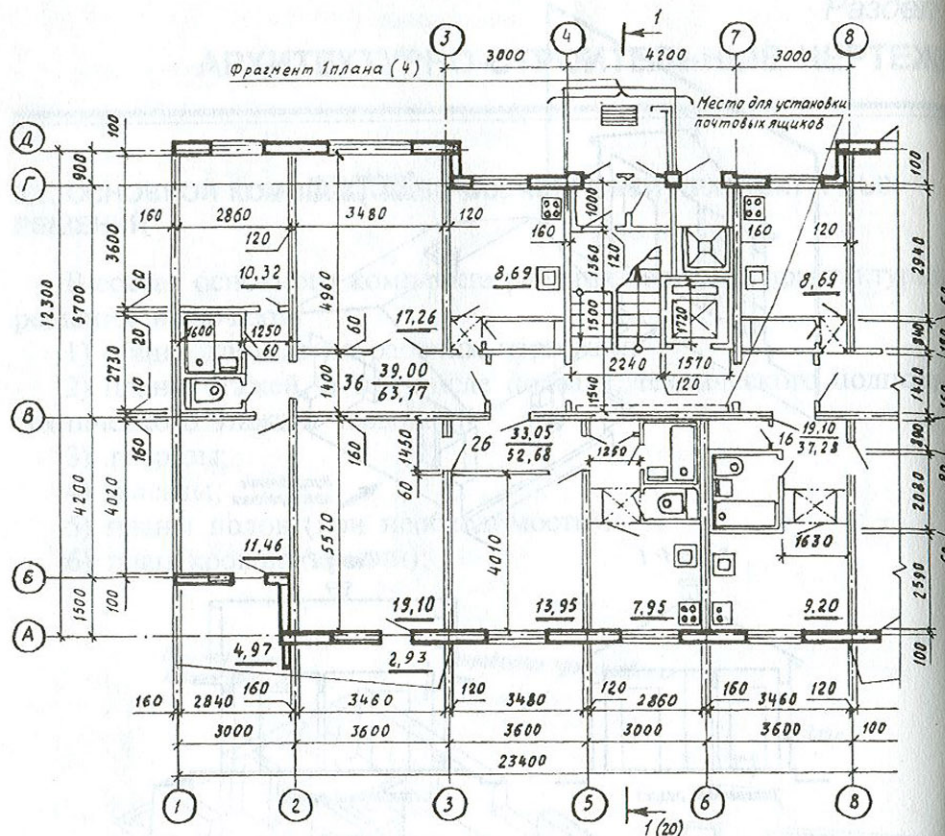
Пример выполнения плана 1-го этажа жилого дома
